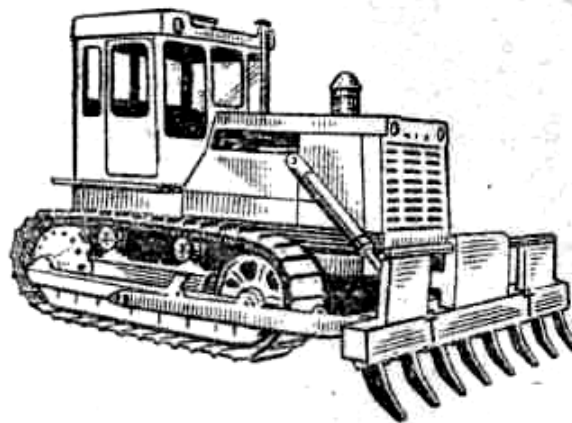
Общий вид корчевателя – собирателя с наклонными подъемными гидроцилиндрами
